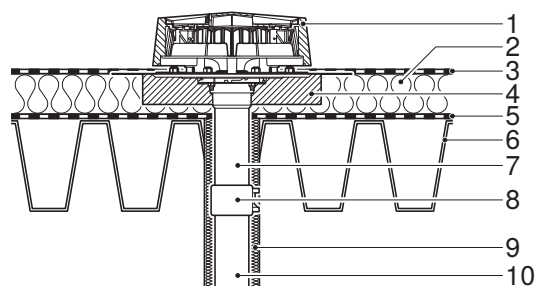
Montage dans toiture en bac d'acier isolée avec revêtement d'étanchéité
